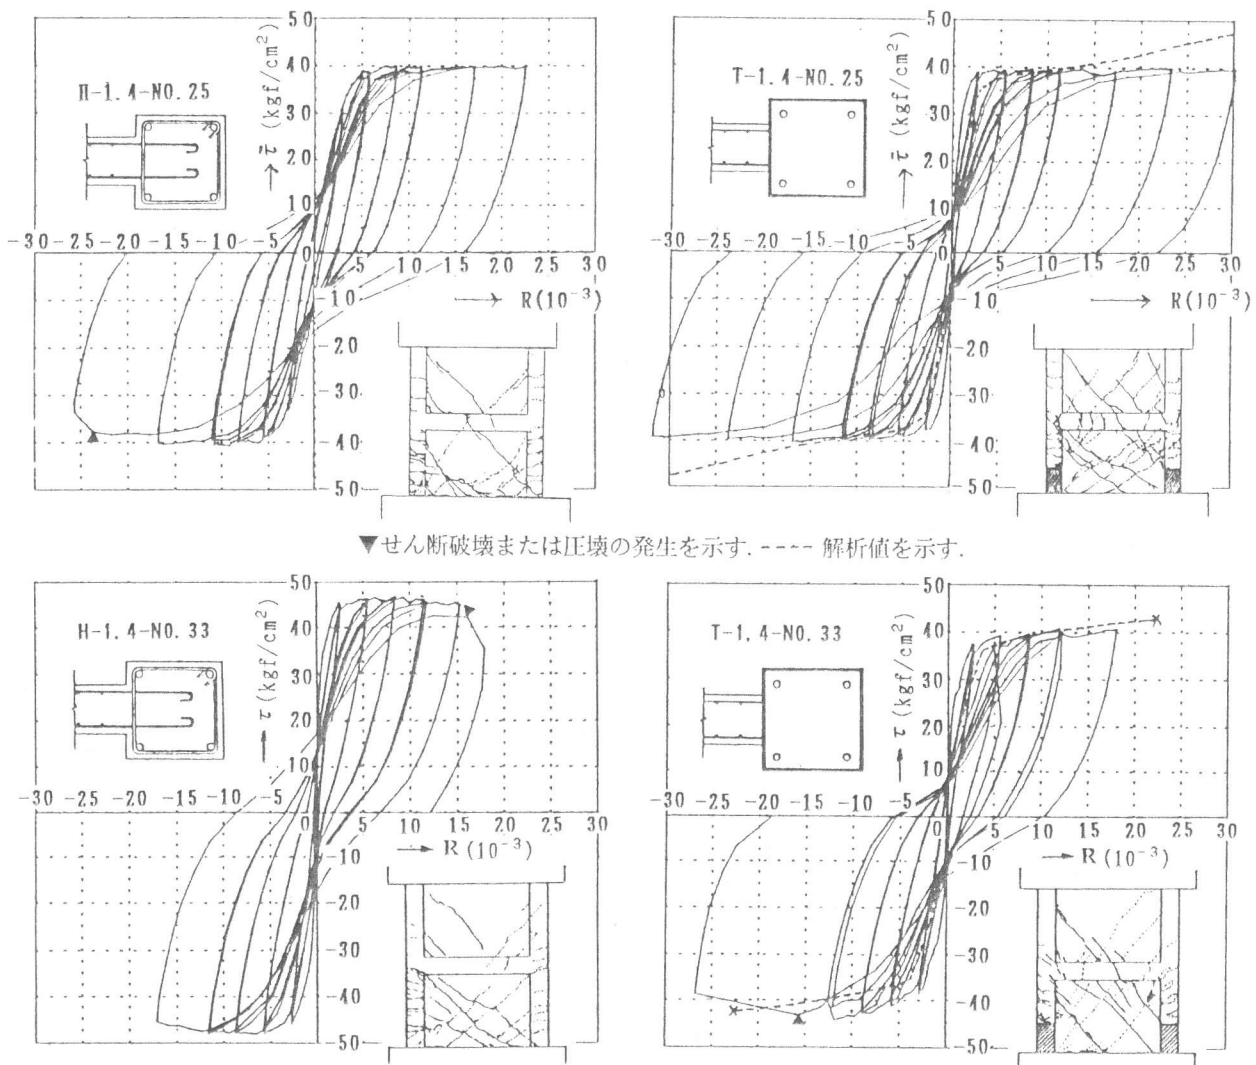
せん断スパン比1.4の各試験体の履歴性状および終局時ひび割れ状況
